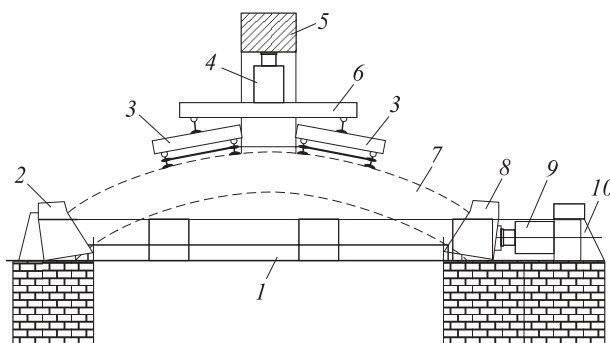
Усовершенствованная система нагружения для исследования огнестойкости железобетонных тубингов: 1 — горизонтальная рама; 2 — неподвижная опора домкрата; 3 — рамы для создания вертикальной нагрузки; 4 — гидравлический домкрат для вертикальной нагрузки; 5 — вертикальная рама; 6 — упор домкрата; 7 — испытуемый образец; 8 — подвижная опора; 9 — гидравлический домкрат для горизонтальной нагрузки; 10 — опора гидравлического домкрата
